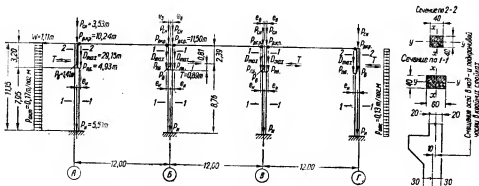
Расчетная схема поперечника и схема нагрузок.
